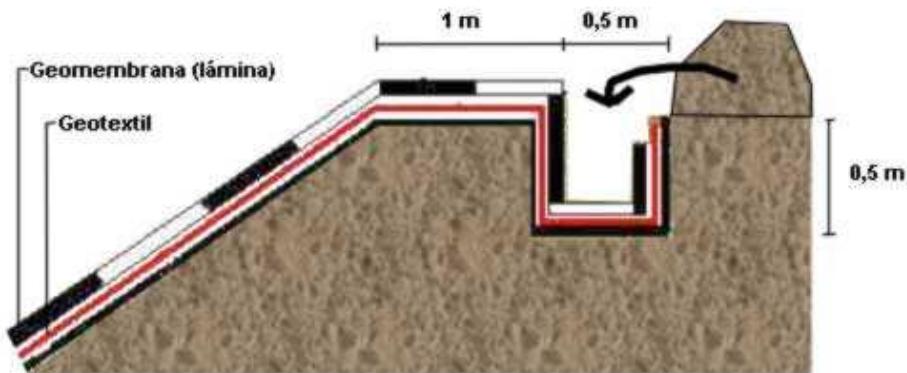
Dimensiones aconsejadas en la zanja de anclaje
